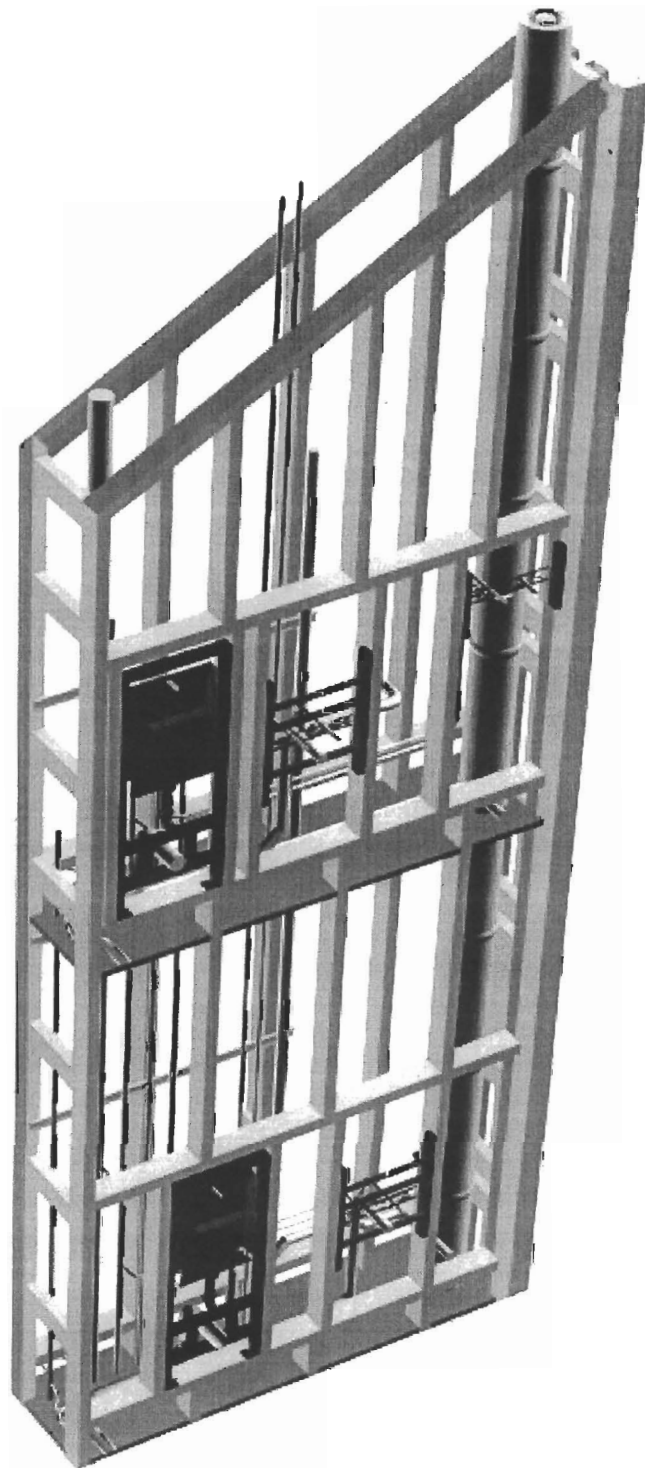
Ansicht eines geschosübergreifenden Installationskernes ohne Beplankung.
